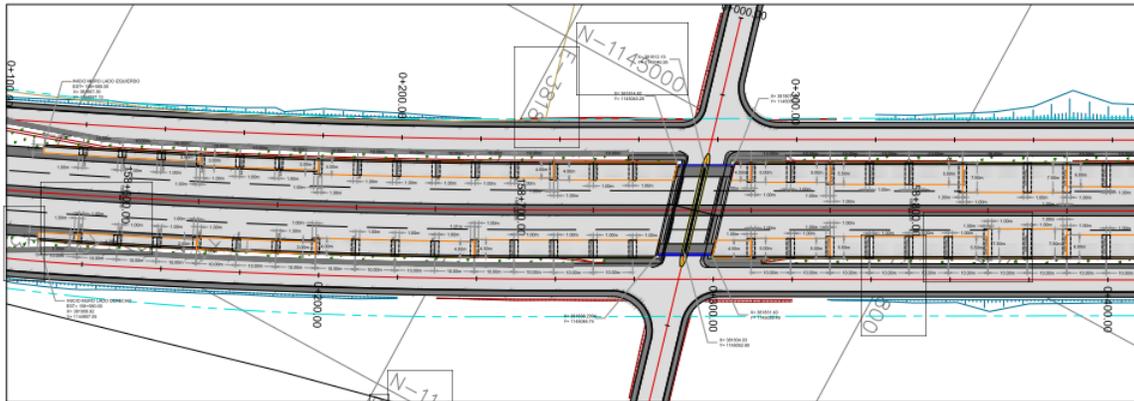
Planta de diseño de conjunto intercambio San Miguel.
